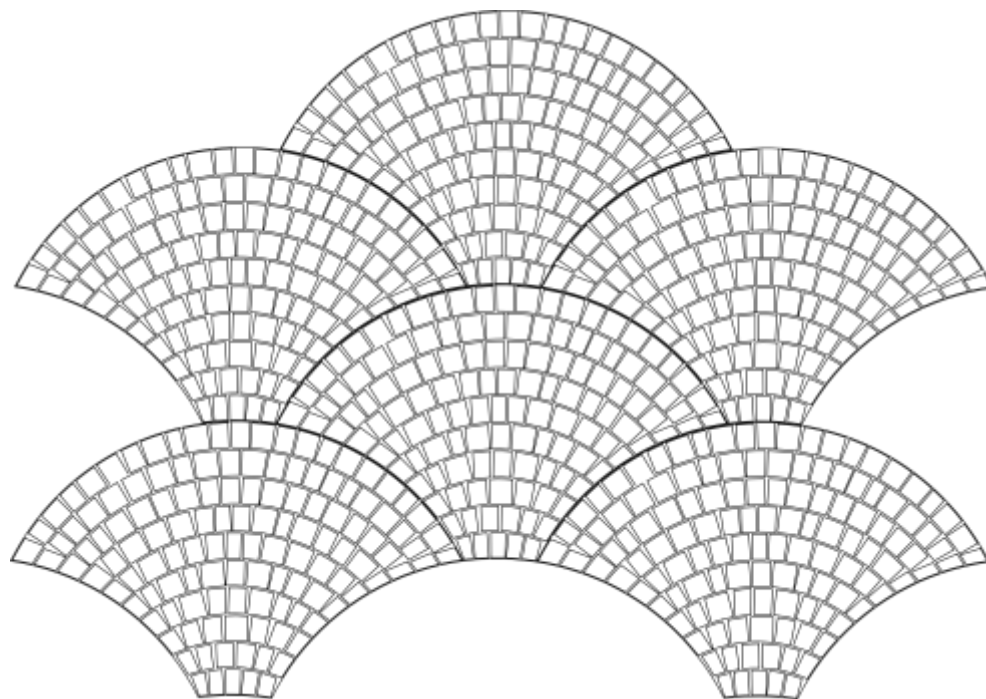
Dettaglio del sistema di posa della nuova pavimentazione in porfido.
